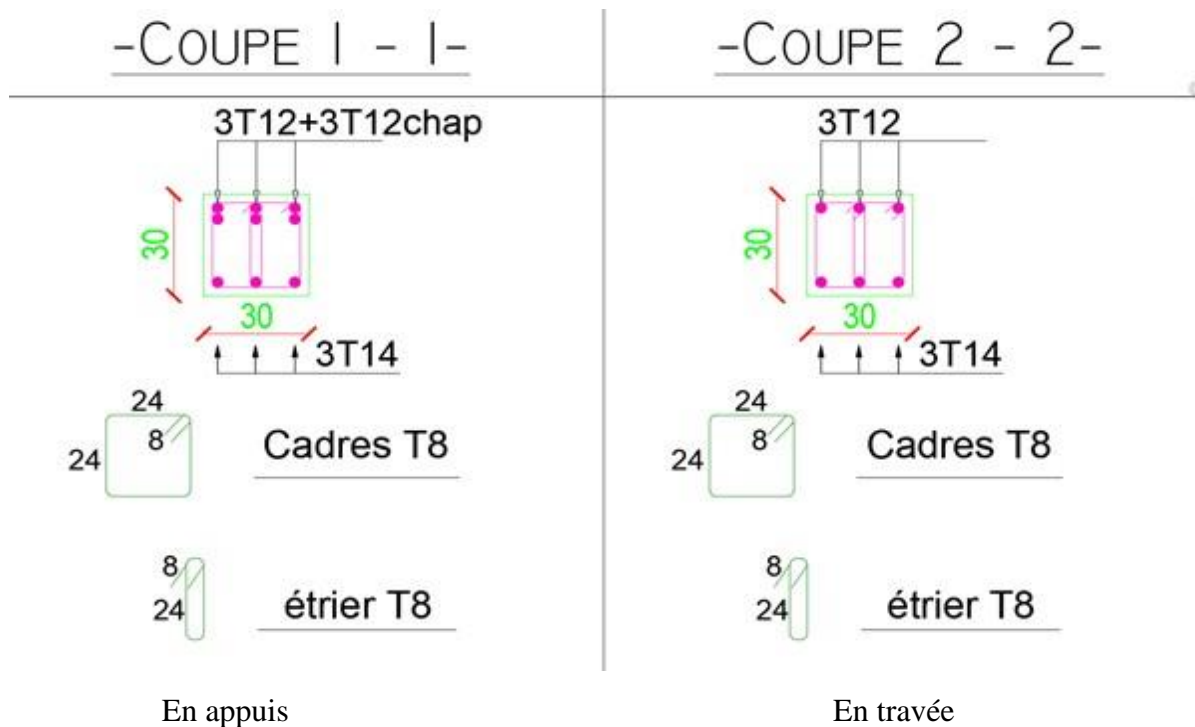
Schéma Ferrailage des poutres secondaire (30x30)
